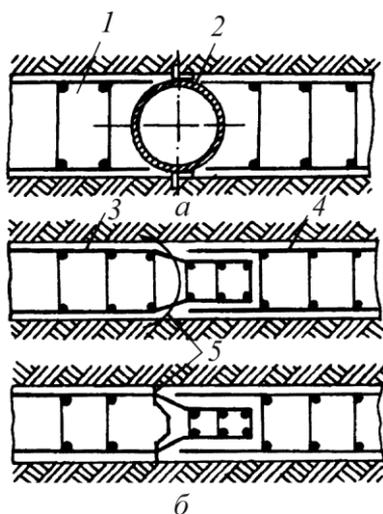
Стыки между захватками монолитных стен: *а* – нерабочий стык; *б* – рабочие стыки; 1 – траншея; 2 – ограничитель захваток; 3, 4 – арматурный каркас; 5 – диафрагма
